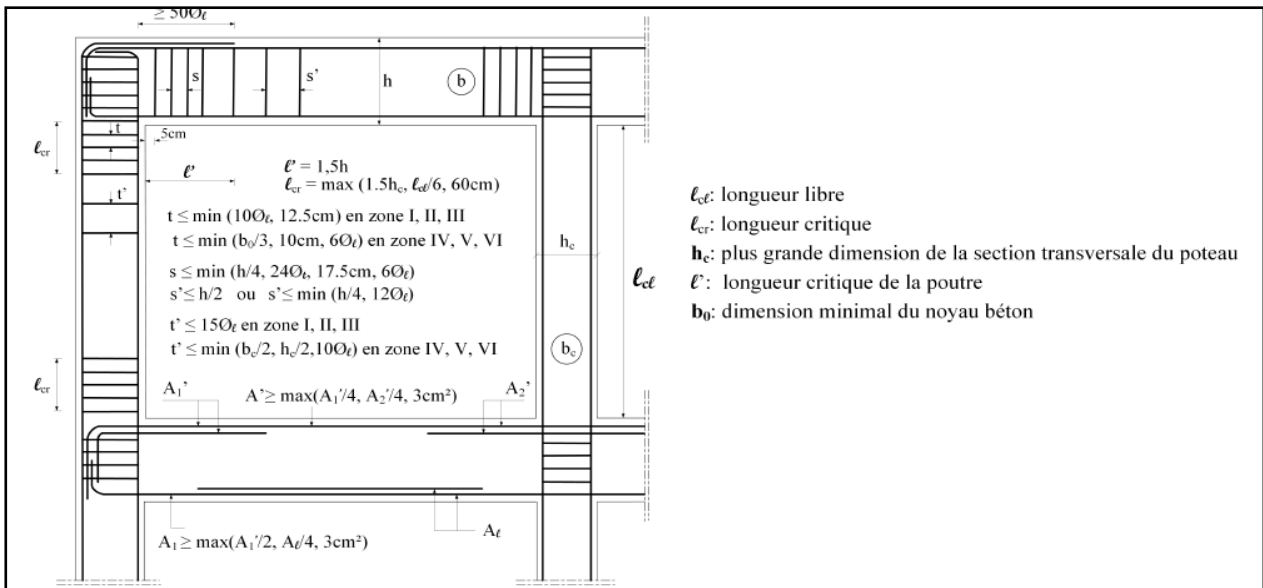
Détail d'un croquis d'armatures transversales de la zone nodale RPA 2024
